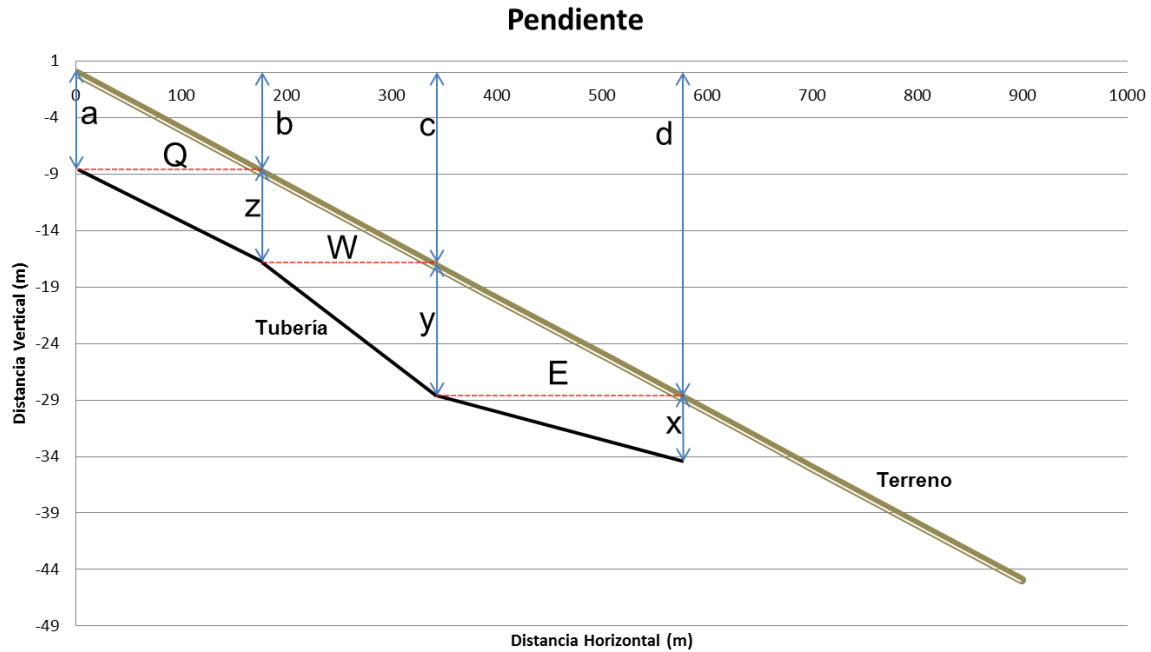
Vista perfil de una distribución de 3 tuberías para un terreno con pendiente.
